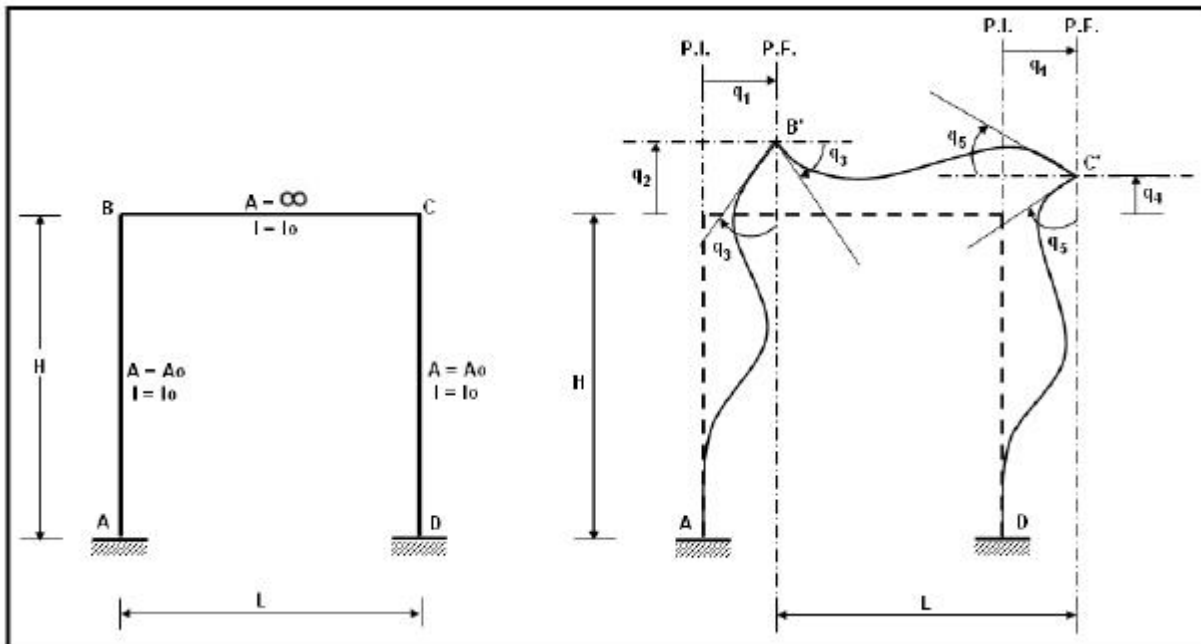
Pórtico plano con una viga axialmente rígida y deformada general.
